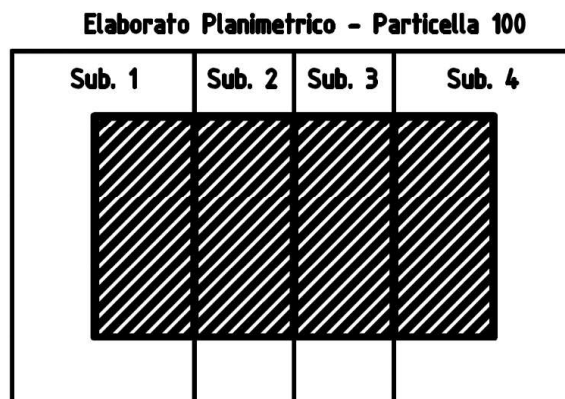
Suddivisione interna del lotto urbano attraverso l'elaborato planimetrico (villette a schiera)
